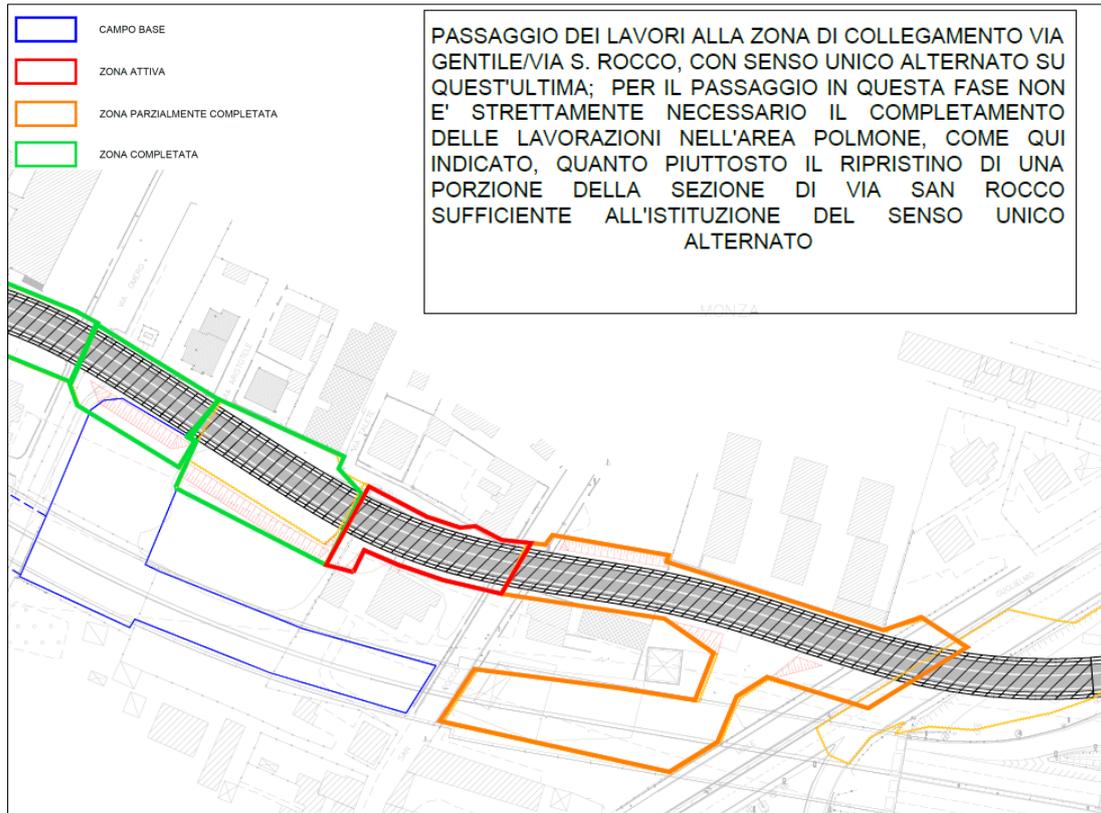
Fasi realizzazione copertura galleria del Piano di Sicurezza di progetto illustrativo della fase G di scavo della galleria
